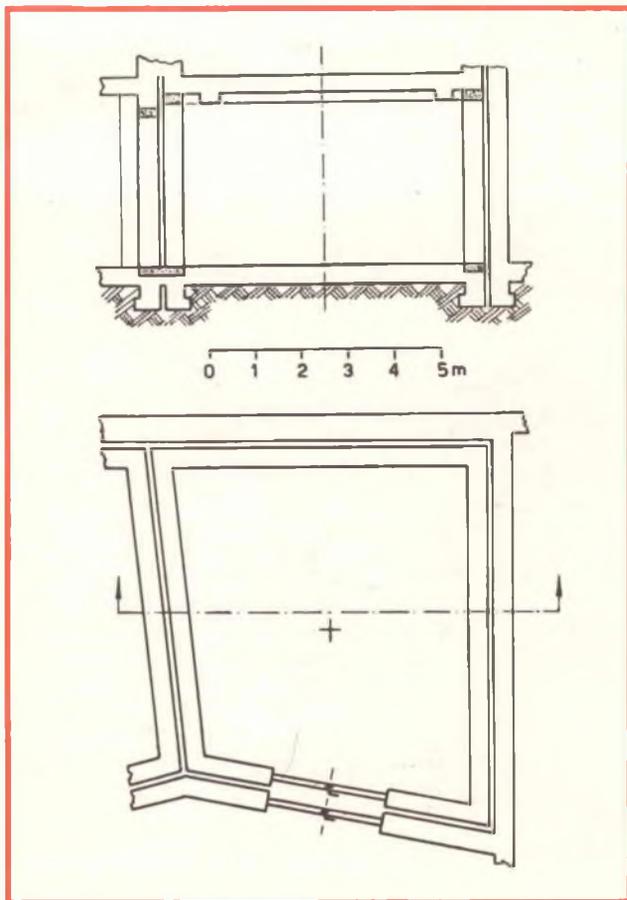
Sezione e pianta della camera riverberante di misura.
